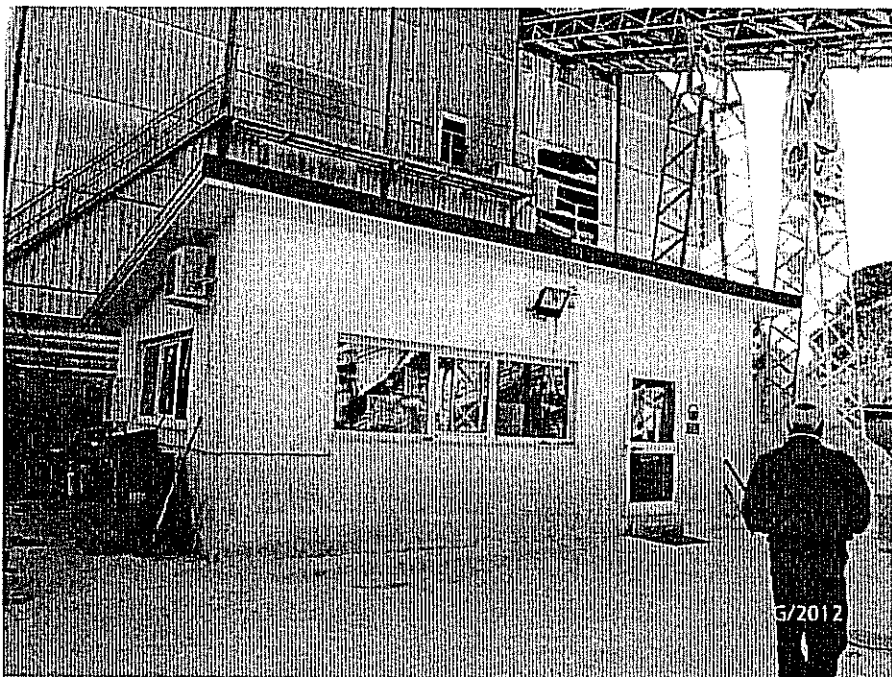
Manufatto edilizio a servizio dell'impianto di frantumazione inerti
